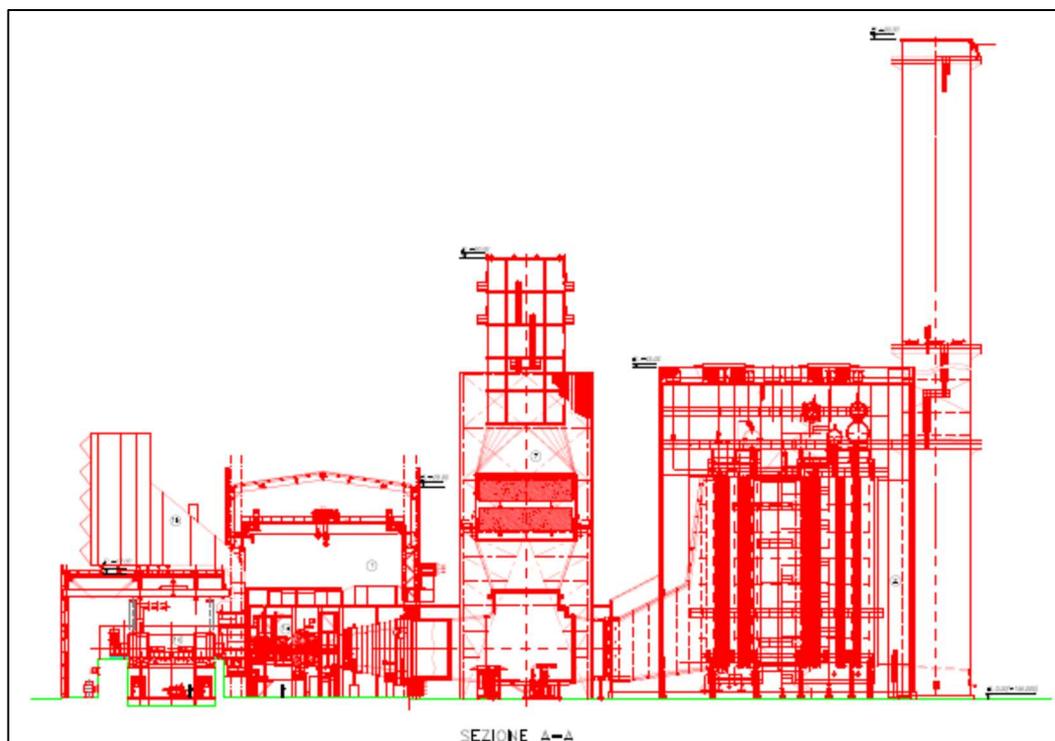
Stralcio delle sezioni delle apparecchiature e dei relativi camini
